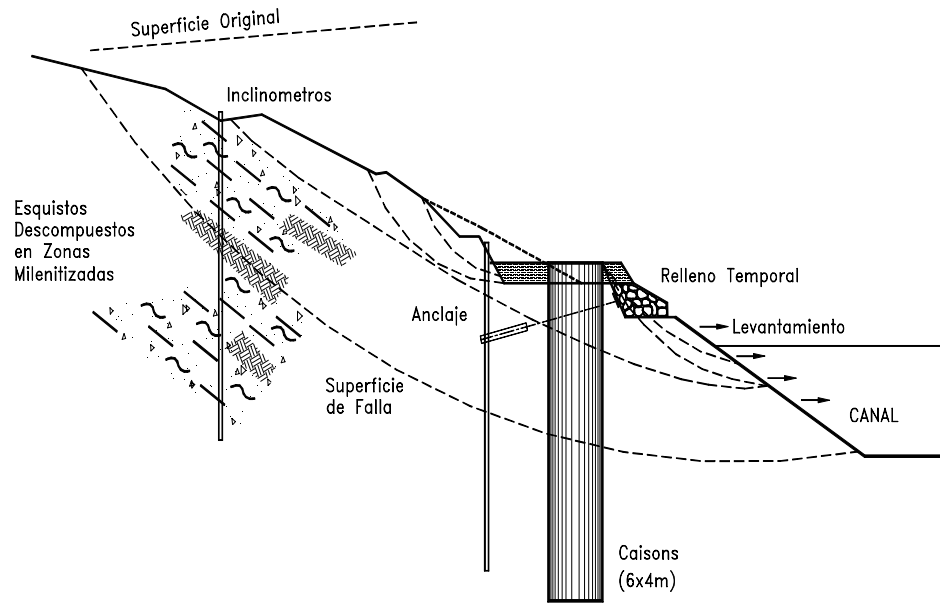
Utilización de pilas de gran diámetro o caissons para la estabilización de un deslizamiento.
